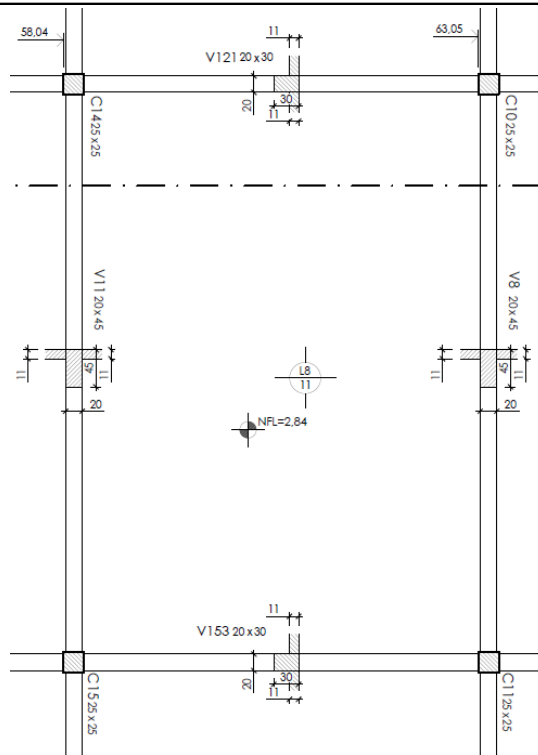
Losa estructural típica de 5 m x 5 m del sector 1 (Fuente: Elaboración propia)
